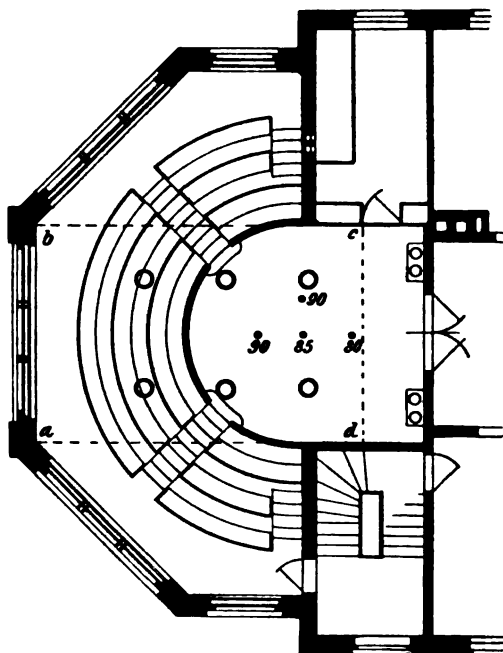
Grundriss der Beleuchtungsanlage.
